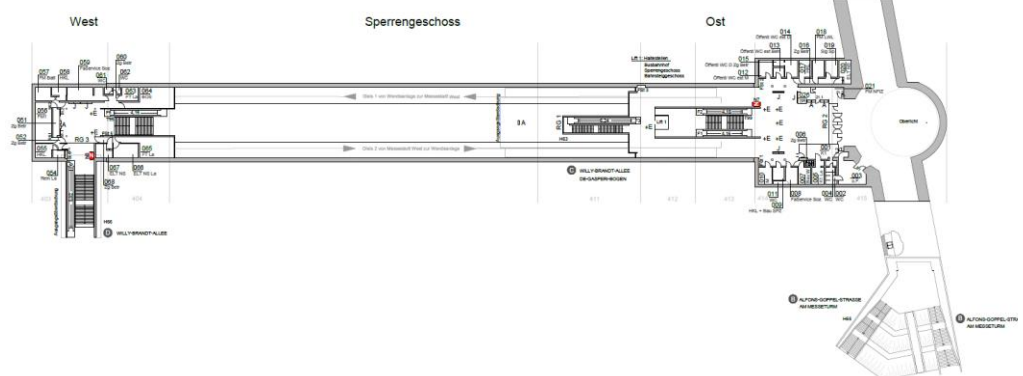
Grundriss Sperrungeschoß MS
